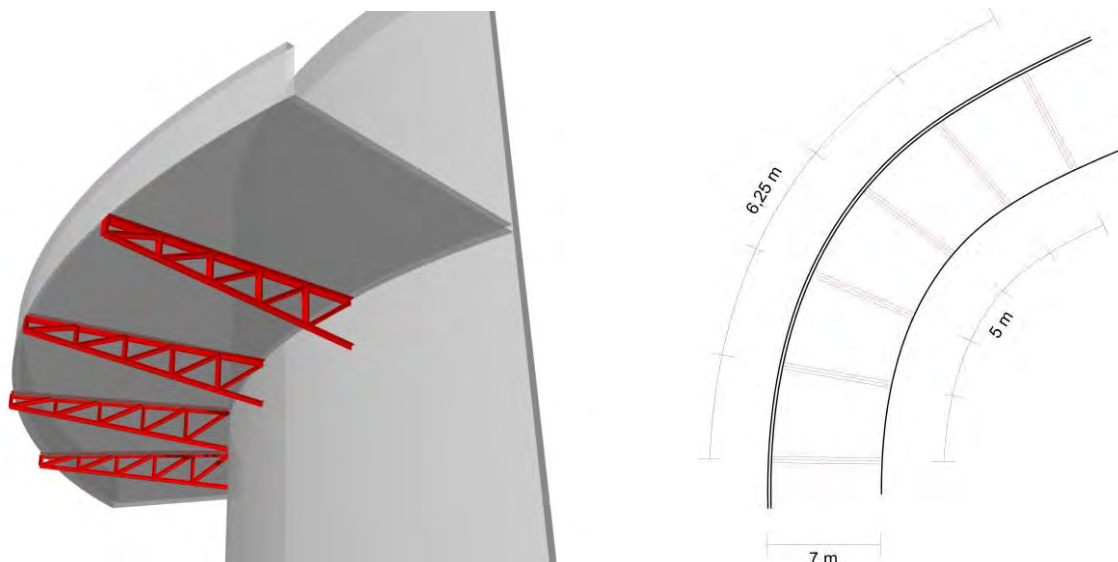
Schema costruttivo tridimensionale con evidenziate le travi reticolari. A destra schema strutturale in pianta estratto per un tronco della rampa elicoidale.
